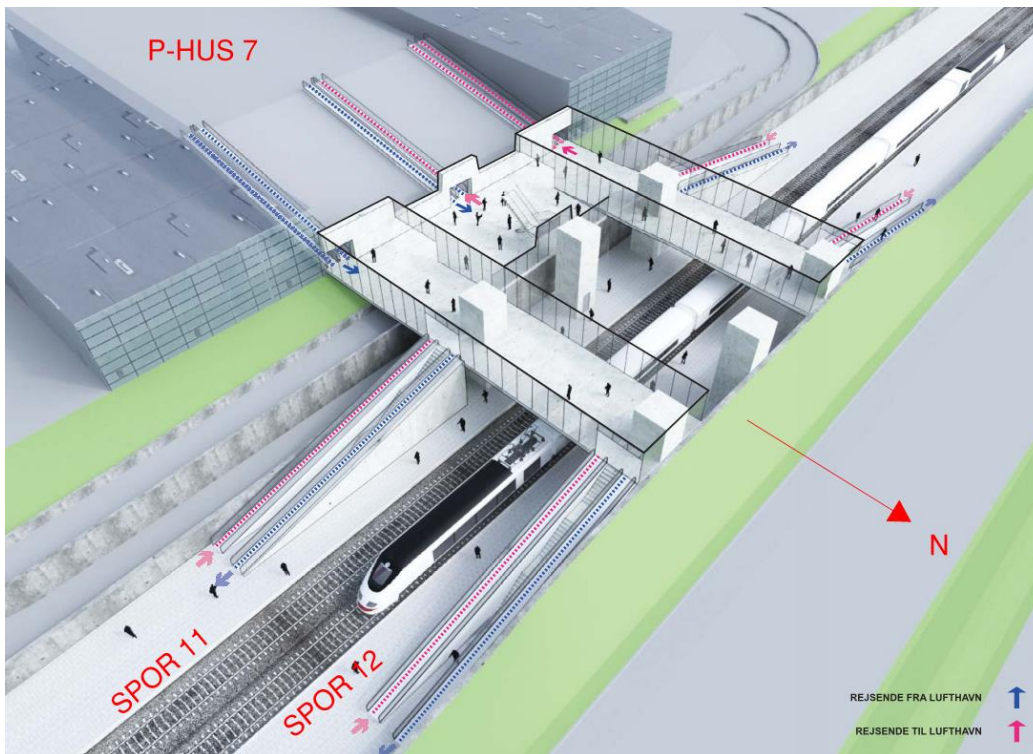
Oversigtsplan Ny Kastrup Lufthavn Station
